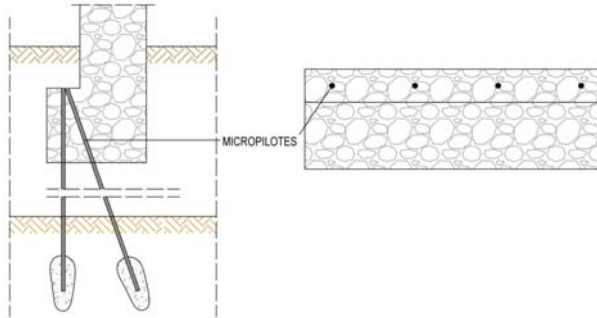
Refuerzo 1 de zapata corrida bajo muro medianero/fachada. Fuente propia.
